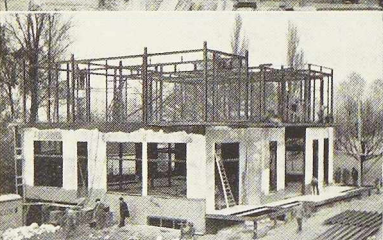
Le 3 novembre 1937, l'ossature est en voie d'achèvement, les planchers du 1^{er} étage sont montés; on a exécuté les enduits extérieurs du rez-de-chaussée.
